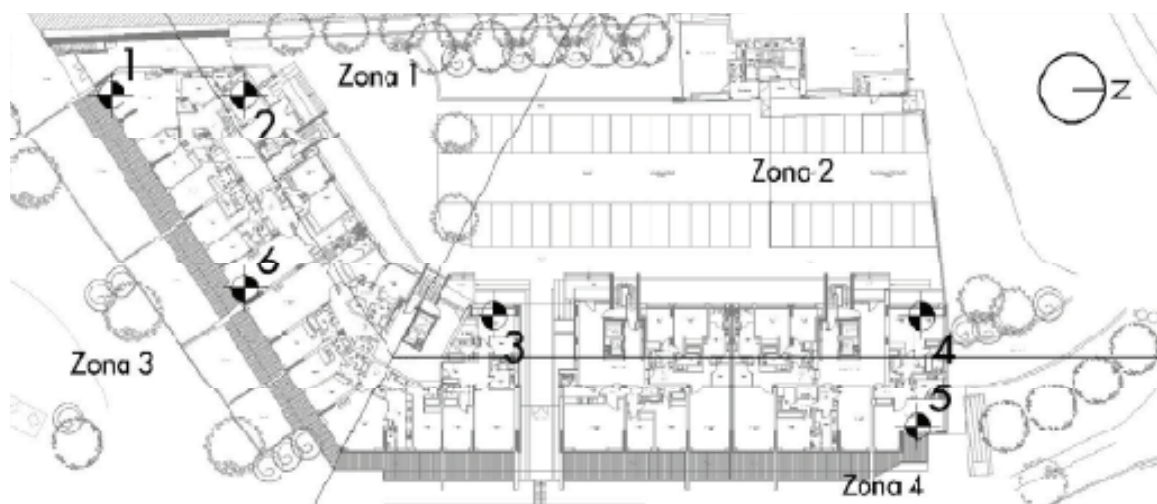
Localização em planta dos pontos de medição ao nível da fachada do edifício.
